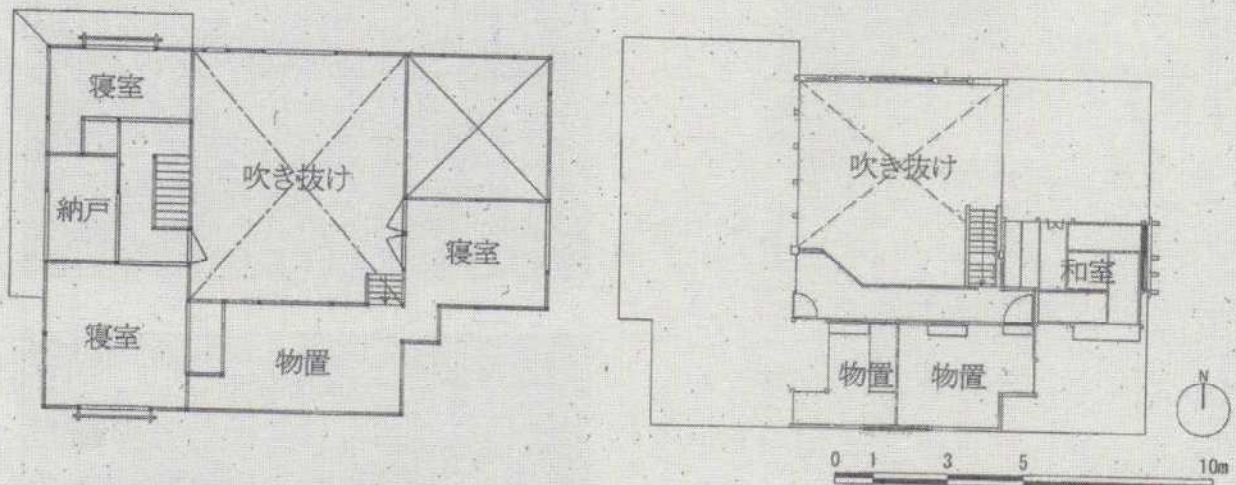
主屋2階平面図 (左:青焼図面 右:現状平面) 1/200
